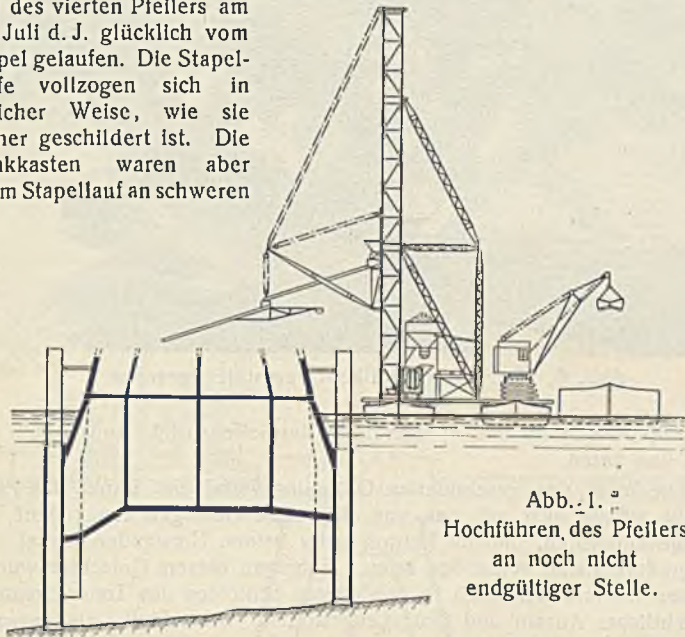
Hochführen des Pfeilers an noch nicht endgültiger Stelle.
